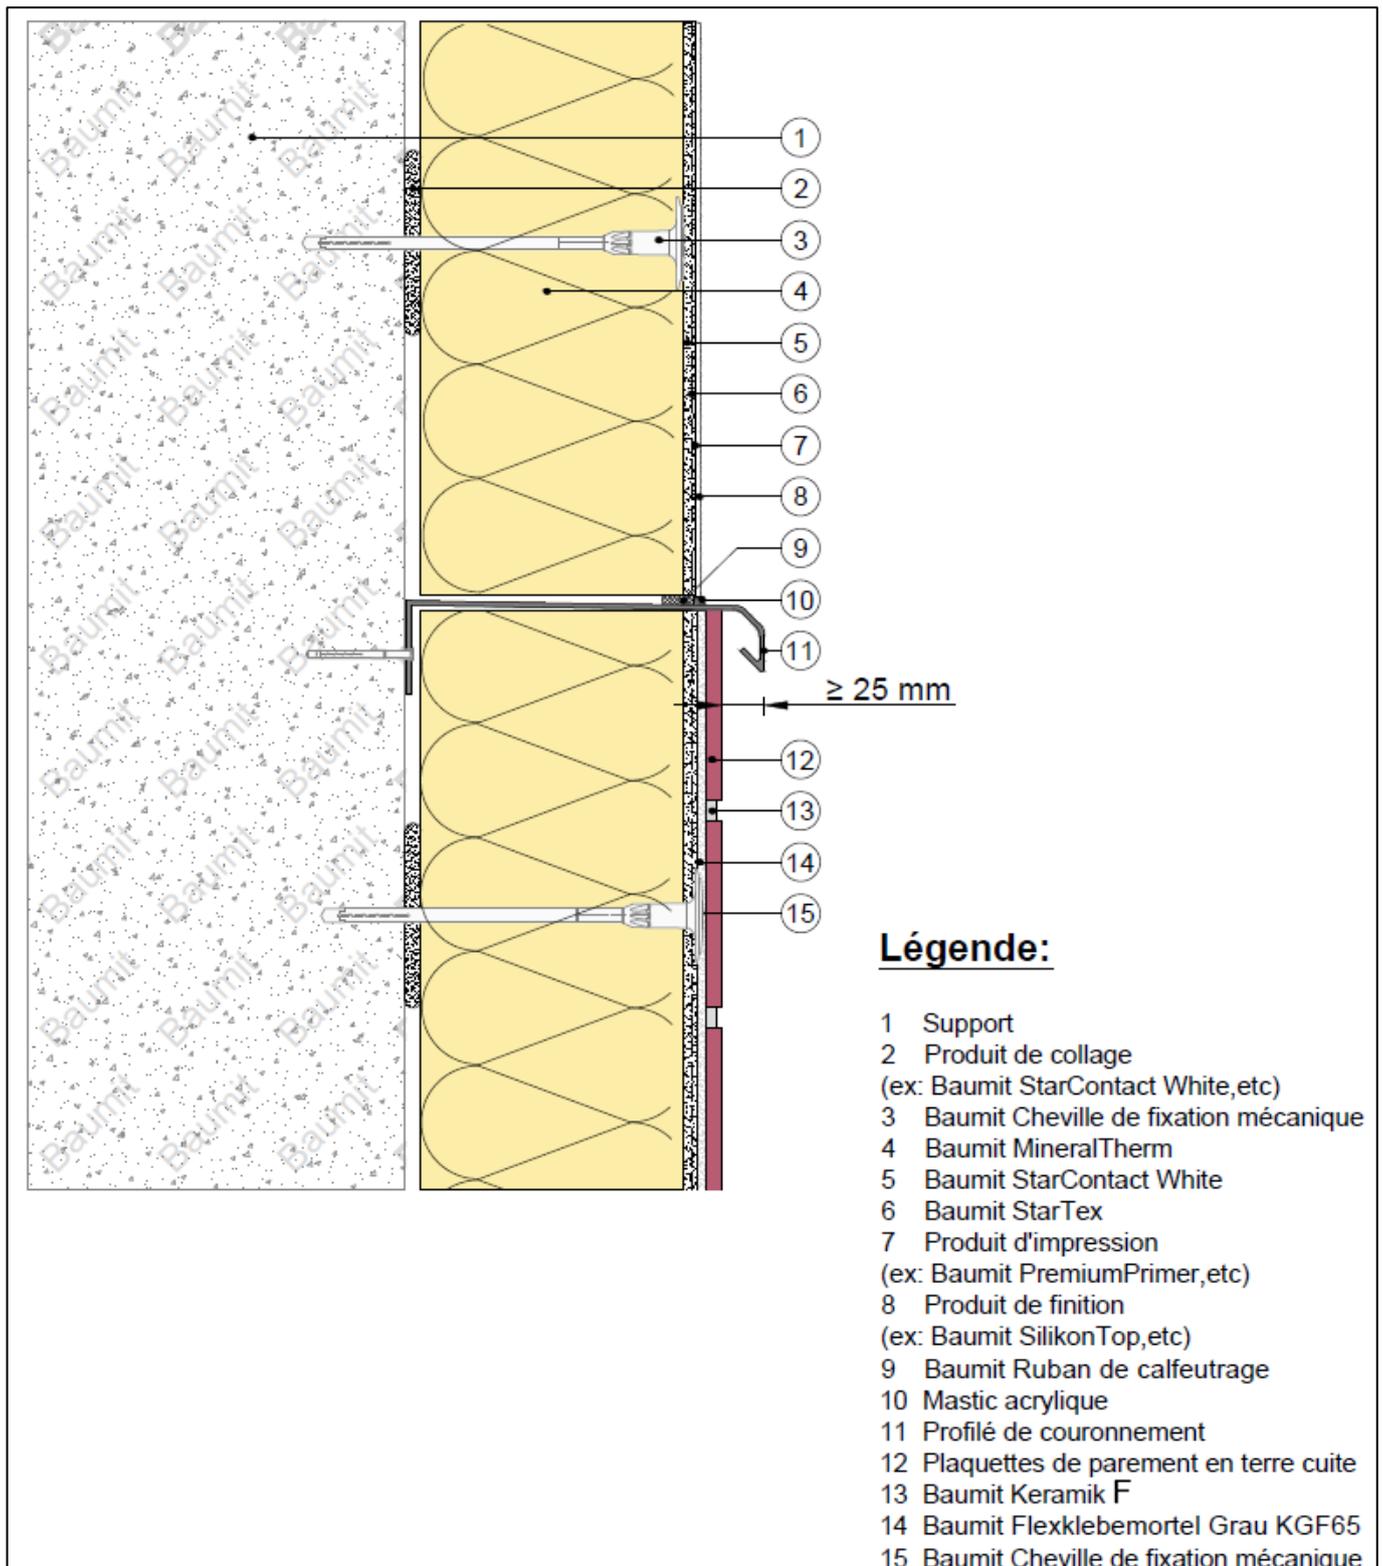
Jonction entre finition par plaquettes et finition par enduit – variante 2
